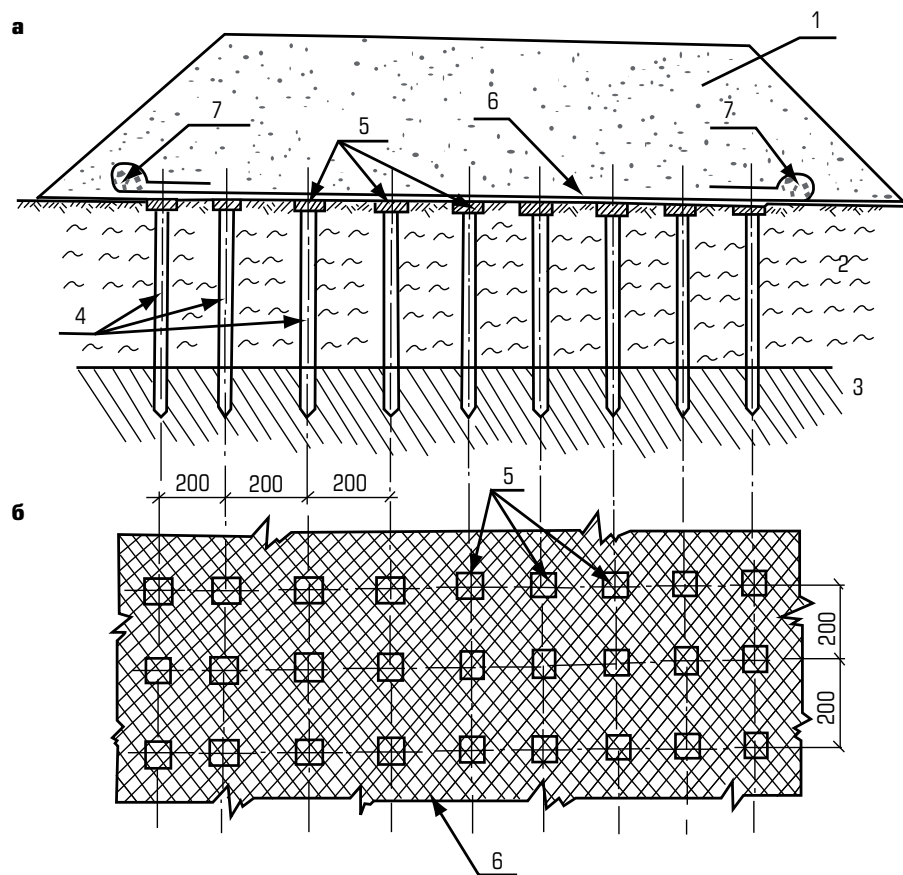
Схема «безосадоочной» насыпи на слабом основании: а) поперечный разрез; б) план армогрунтового ростверка: 1 — тело насыпи; 2 — слабые грунты основания; 3 — более прочные грунты основания; 4 — забивные железобетонные сваи сечением 35 × 35 см; 5 — железобетонные сборные оголовники свай; 6 — армогрунтовый ростверк в виде мембраны из высокопрочной геосинтетической ткани Stabilenka; 7 — анкерные элементы
